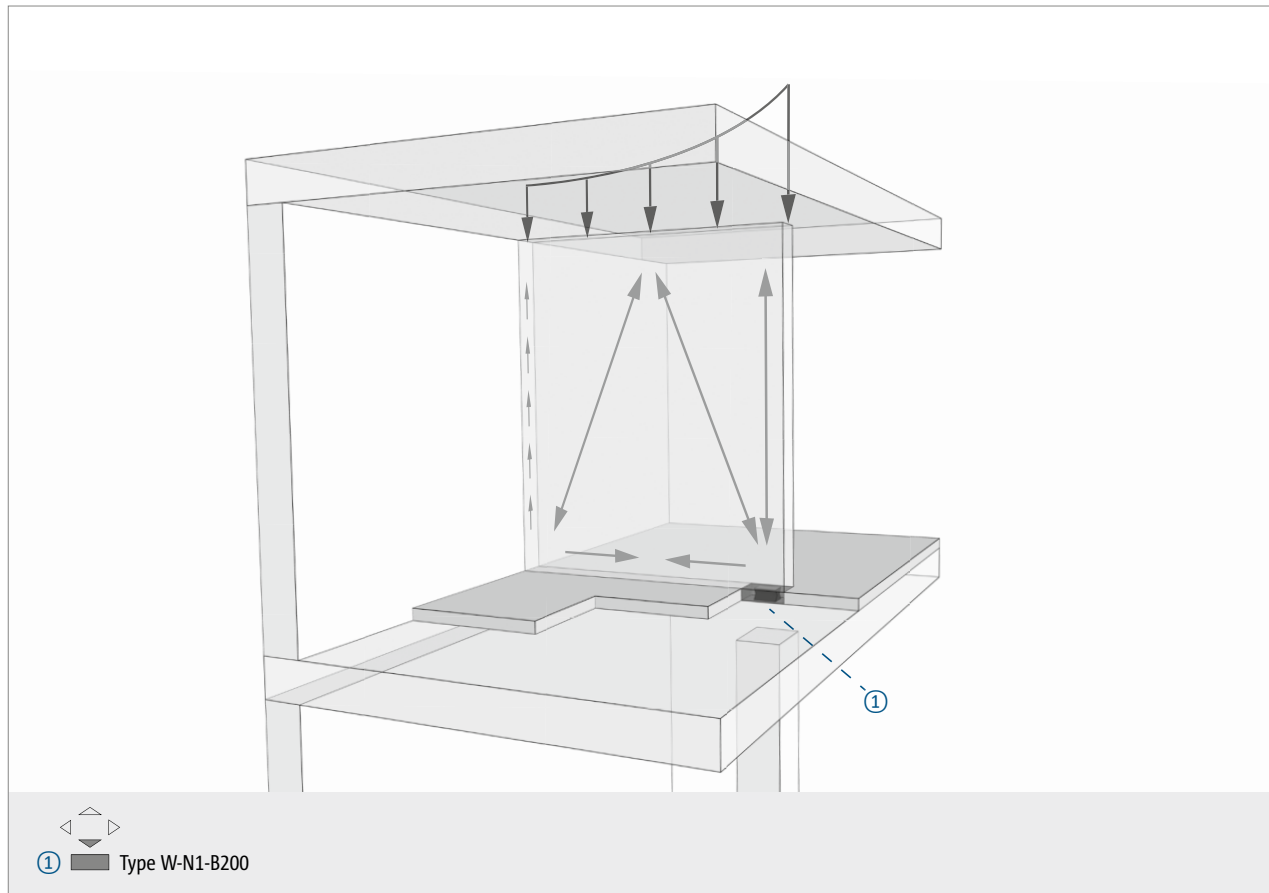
Mur de cage d'escalier sur la dalle, désolidarisé, avec appui ponctuel
